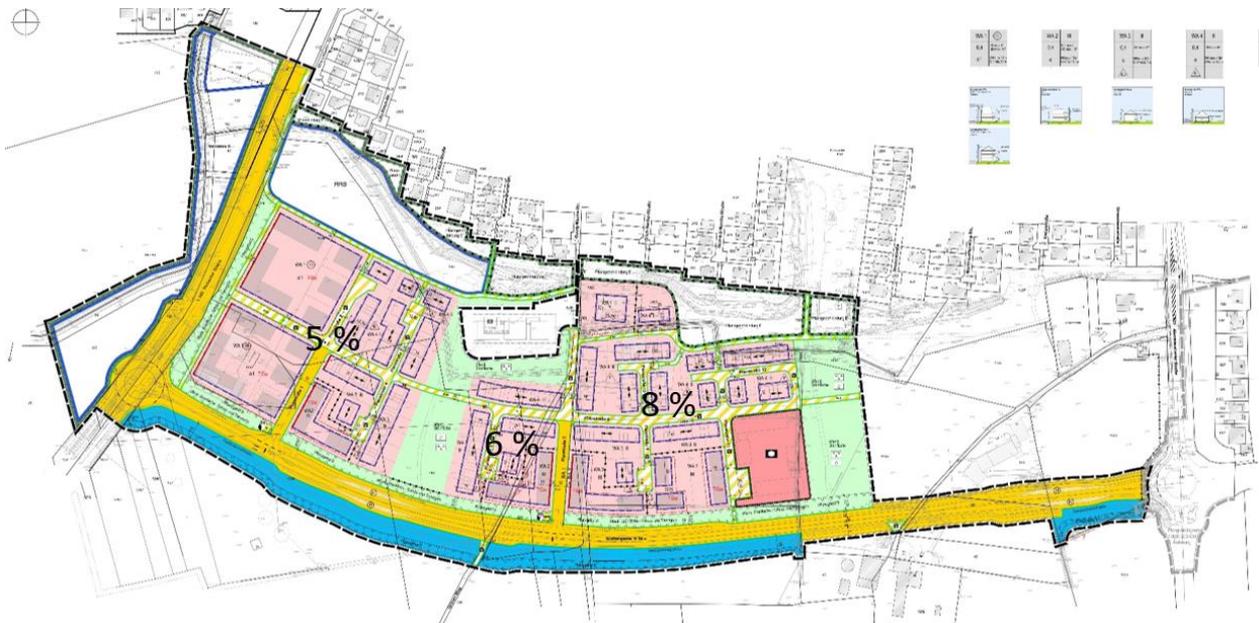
Bebauungsplanentwurf Telgte-Süd
